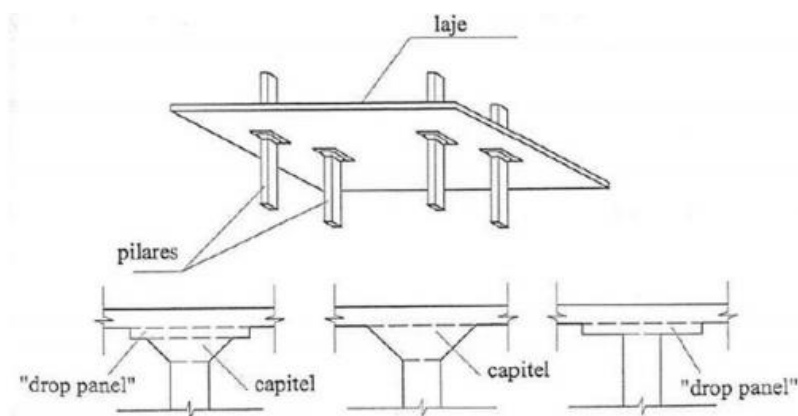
Lajes cogumelo com capitel e ábaco nas ligação com o pilar. (CARVALHO *et al.*,2009)
